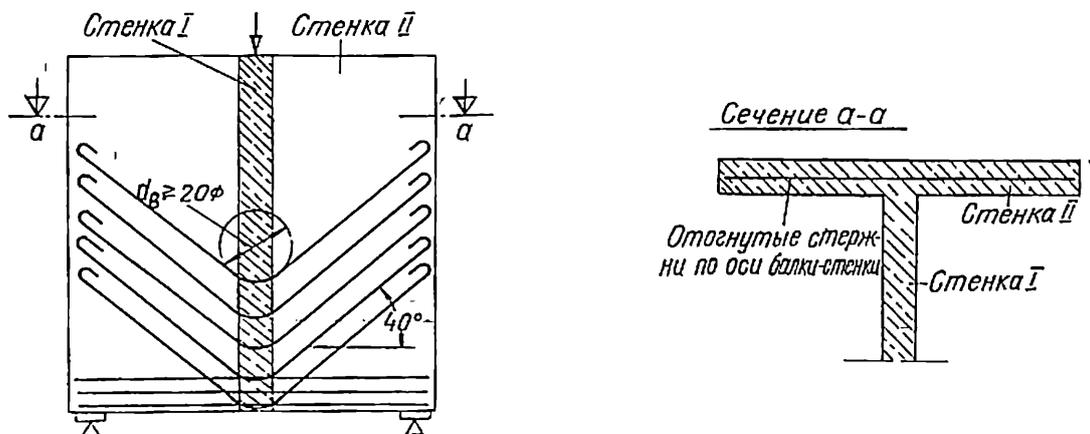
16. Армирование опорной стенки II, воспринимающей подвесную нагрузку с помощью наклонных стержней, приведенных на рис.2.5 - 14 при высоких напряжениях
